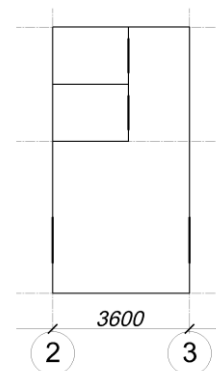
Отверстия в стене (фрагмент плана)
